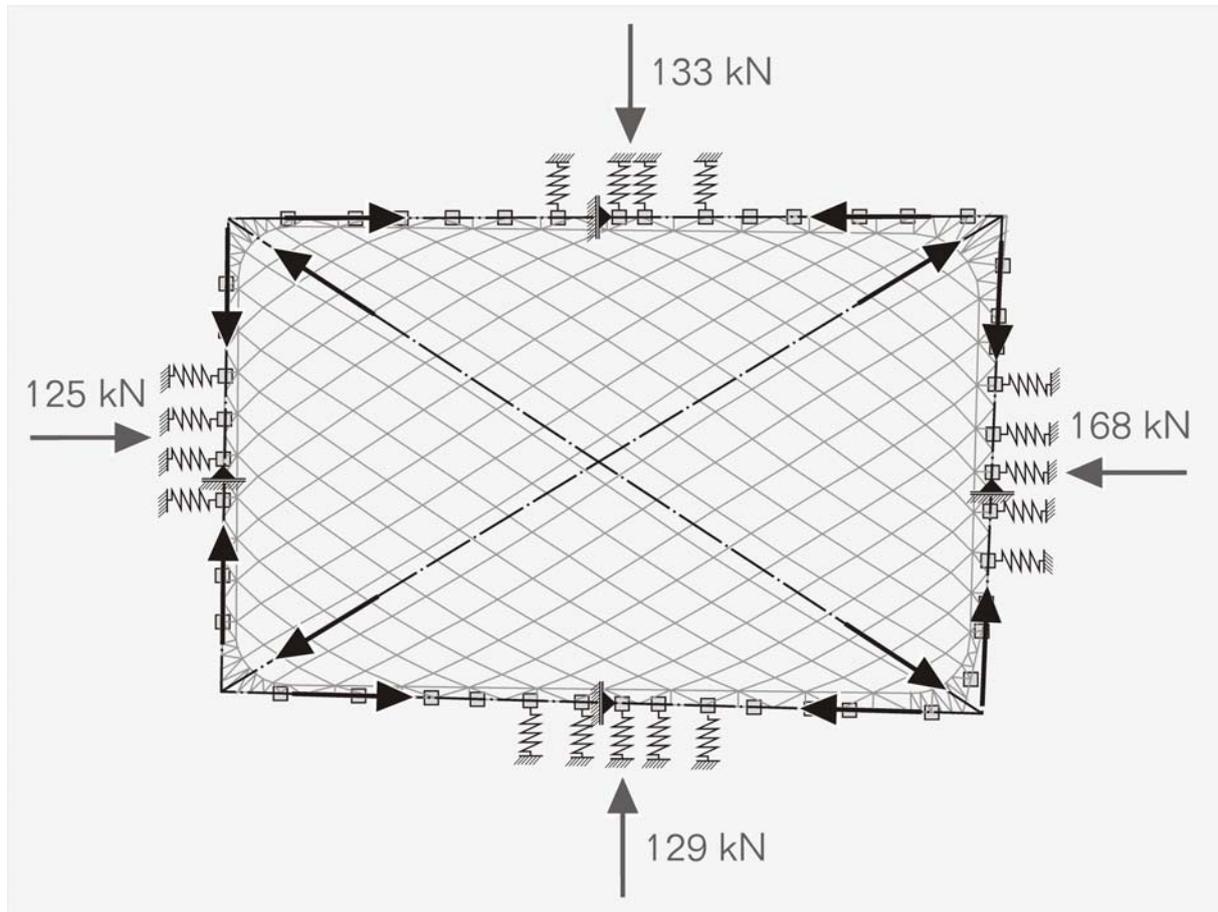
Haupttragwirkung, Lagerschema und resultierende horizontale Auflagerkräfte senkrecht zu den Umfassungswänden
